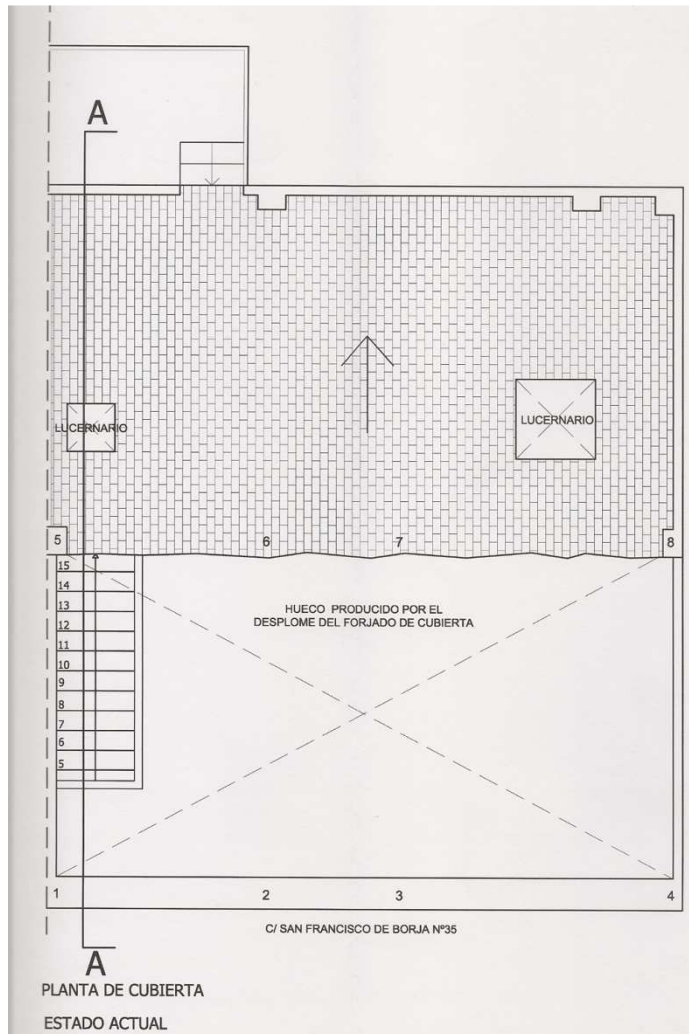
Plano de proyecto indicando el estado después del derrumbe. 2011. Expte. de ruina 7/2011 del archivo del Ayuntamiento de Paterna.
